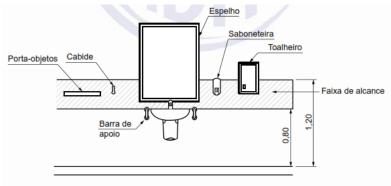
Faixa de alcance de acessórios junto ao lavatório – Vista frontal
